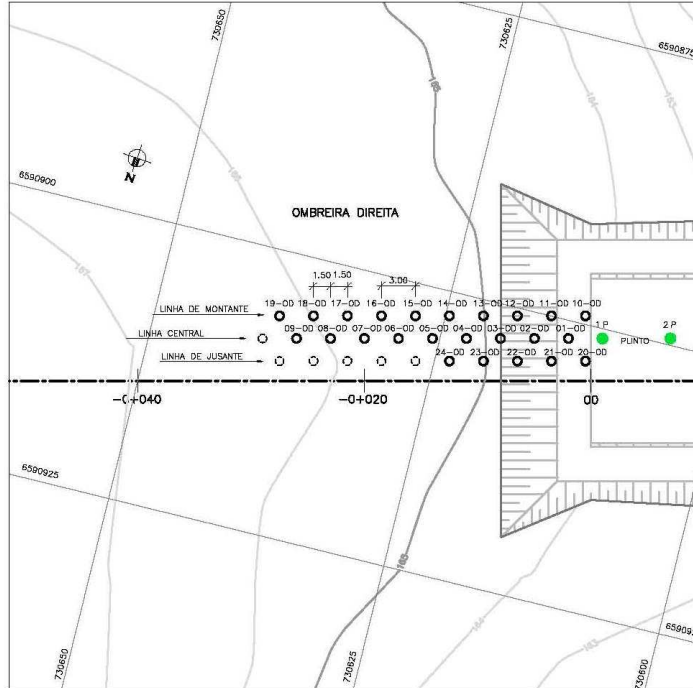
Planta baixa com a localização das injeções na ombreira direita
